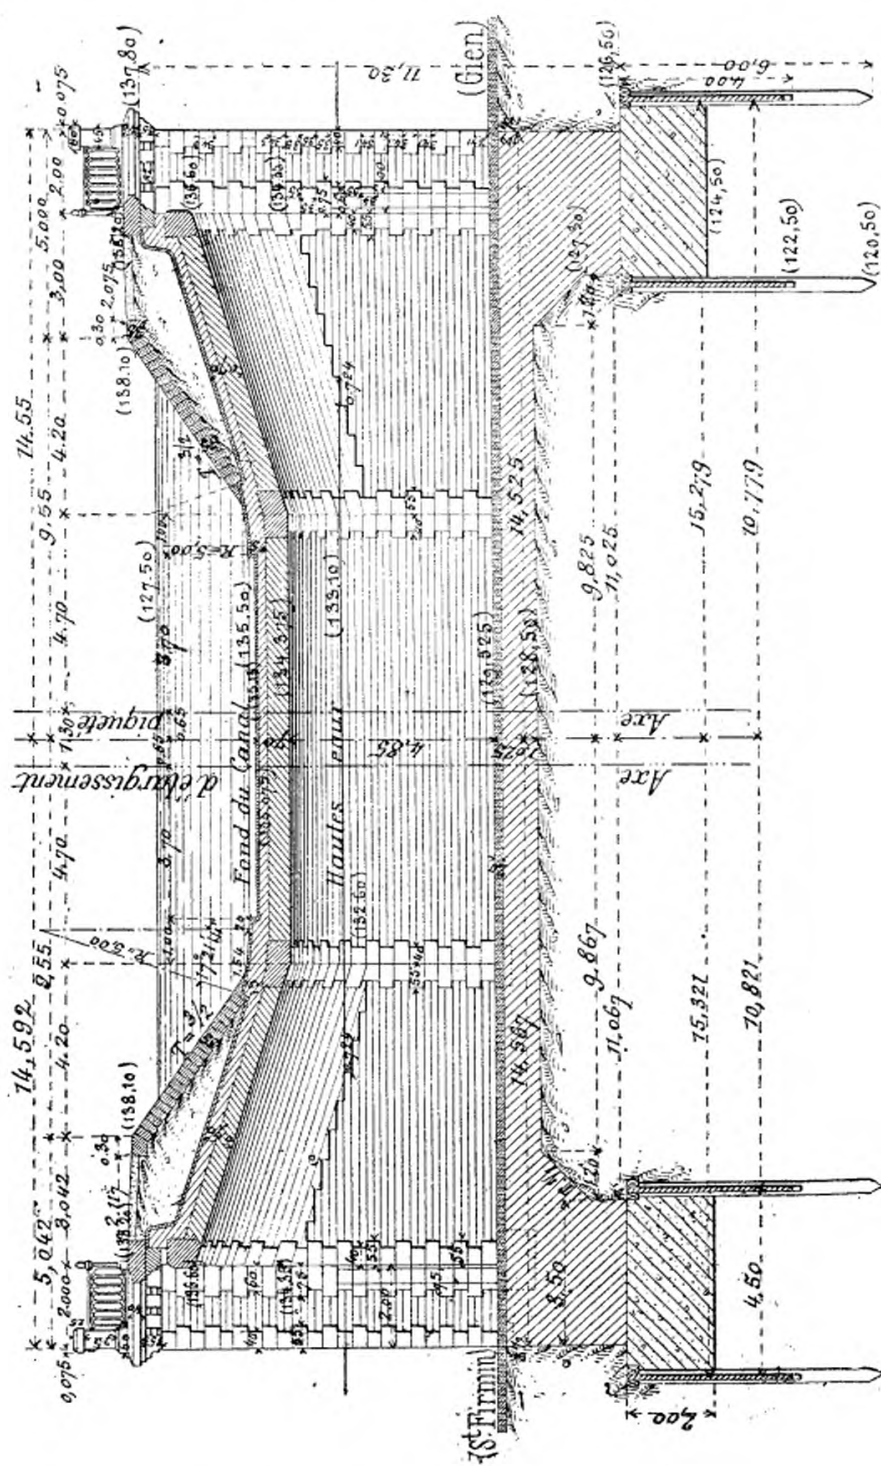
Pont-canal de Saint-Firmin. — Coupe en travers du canal suivant l'axe de la chaussée.
